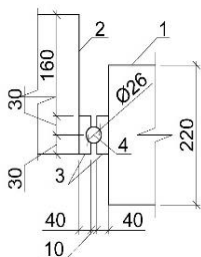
Узел сопряжения железобетонной балки и торцевой траверсы: траверса (1); железобетонная балка (2); металлическая пластина (3); труба сплошного сечения (4).
